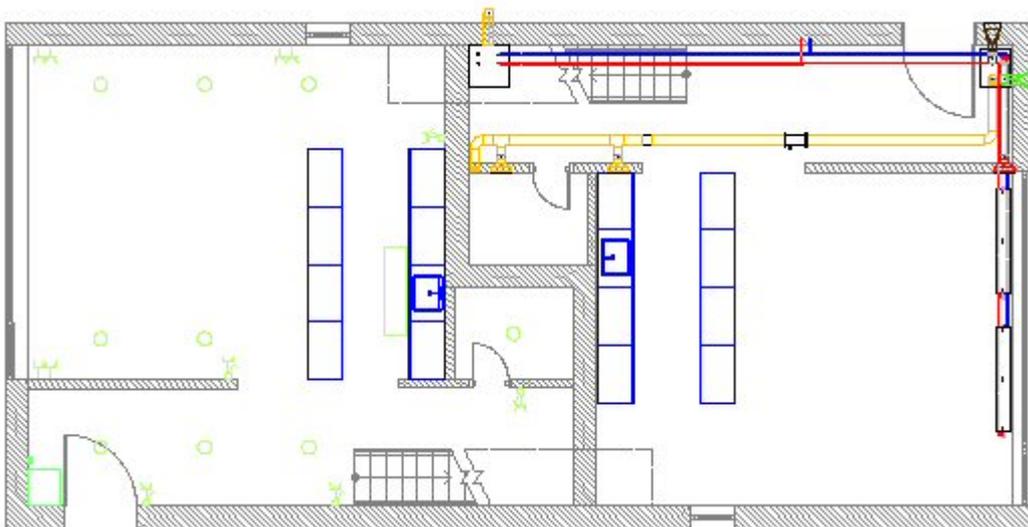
Testbeispiel – Grundriss des EG
